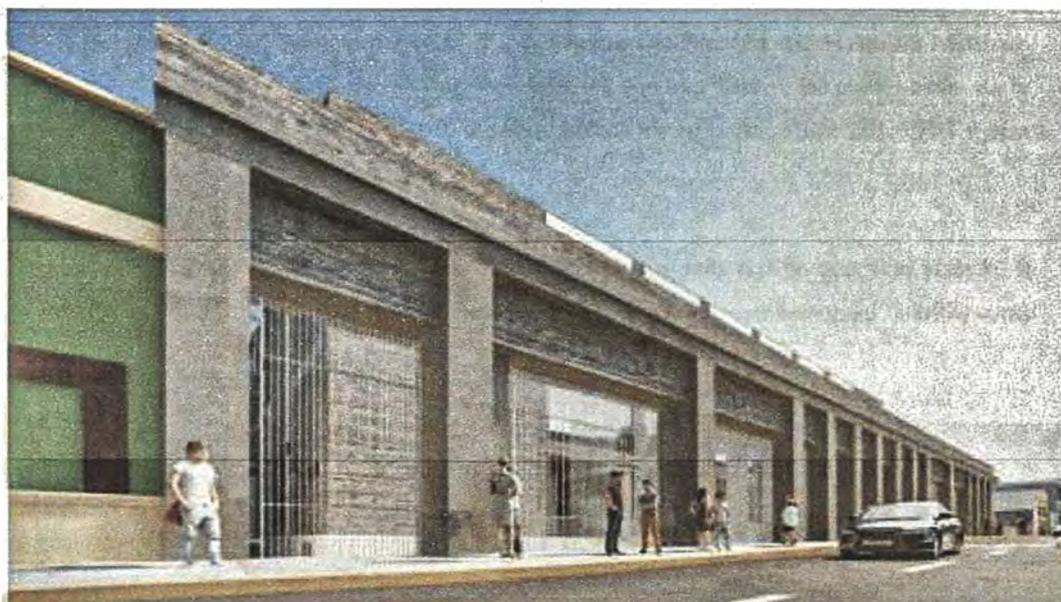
UTP AREQUIPA. Vista de una de las fachadas.
